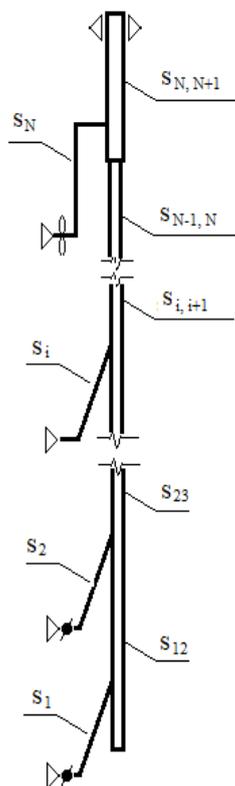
Схема вытяжной вентиляционной системы многоэтажного здания (иллюстрация автора) Fig.1. Scheme of the exhaust ventilation system of a multi-storey building (illustration by the author)
